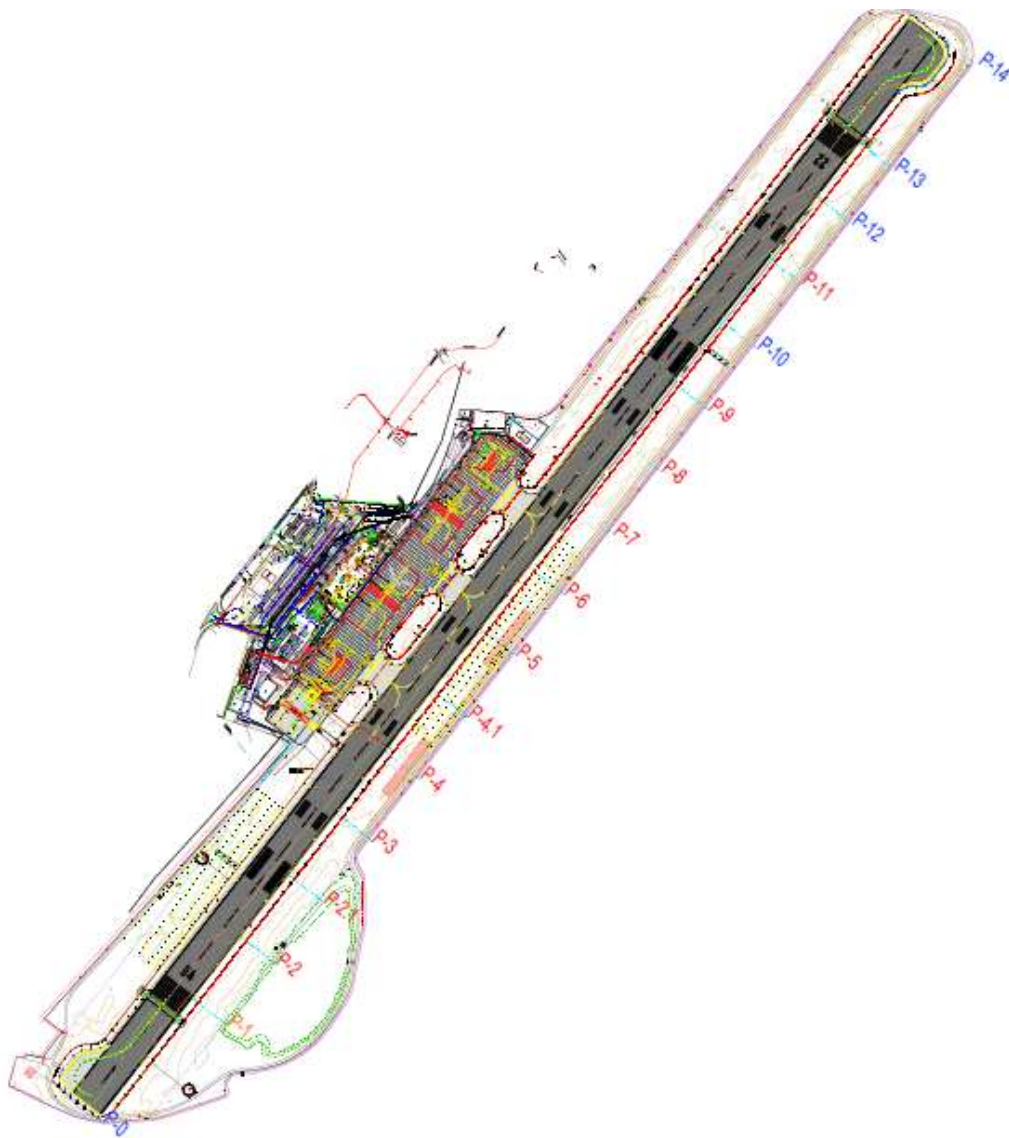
Plano de drenajes del aeropuerto nombrados según videos de inspección
